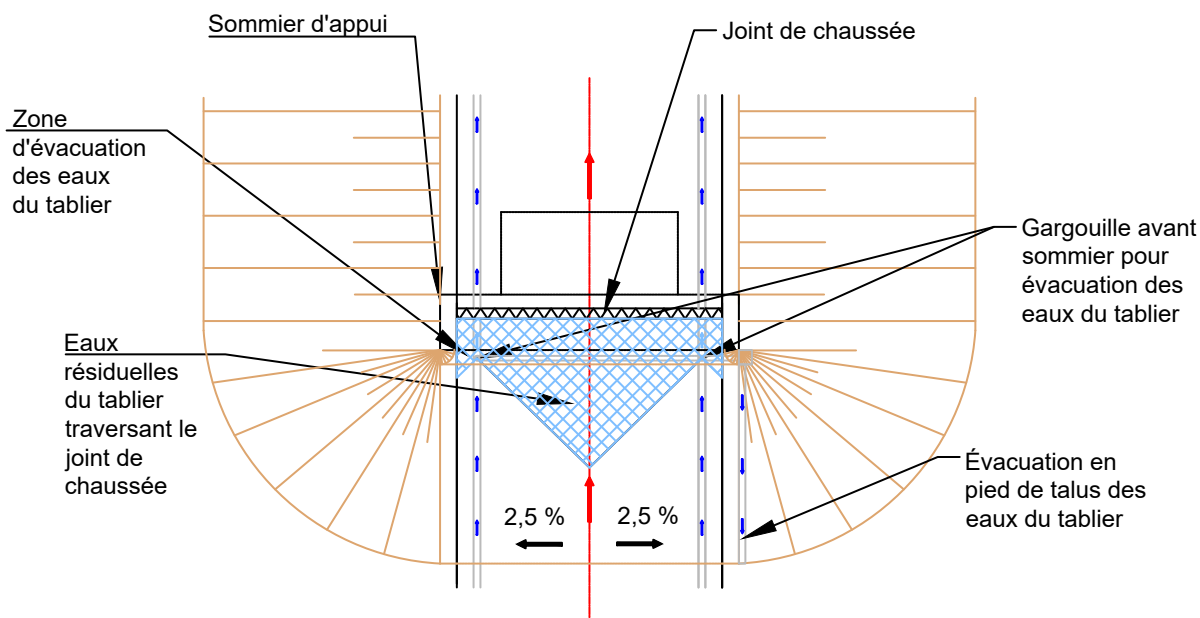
Assainissement en zone d'about via des gargouilles (vue de dessus du tablier)
